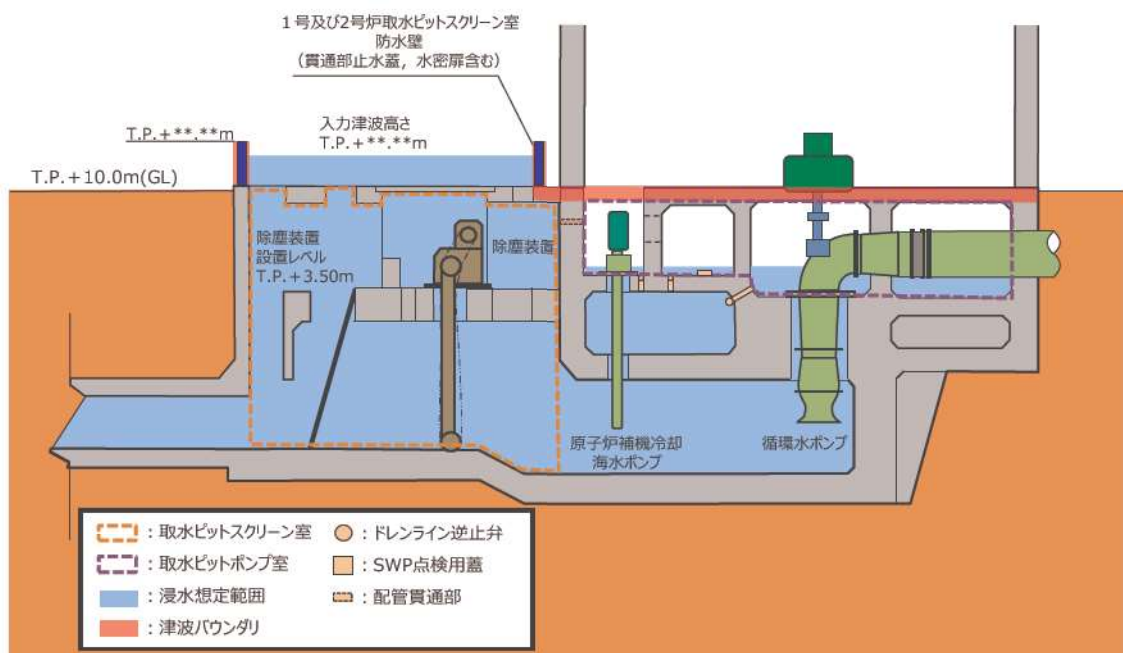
1号及び2号炉取水系統 流入対策配置図 (A-A 断面図)
